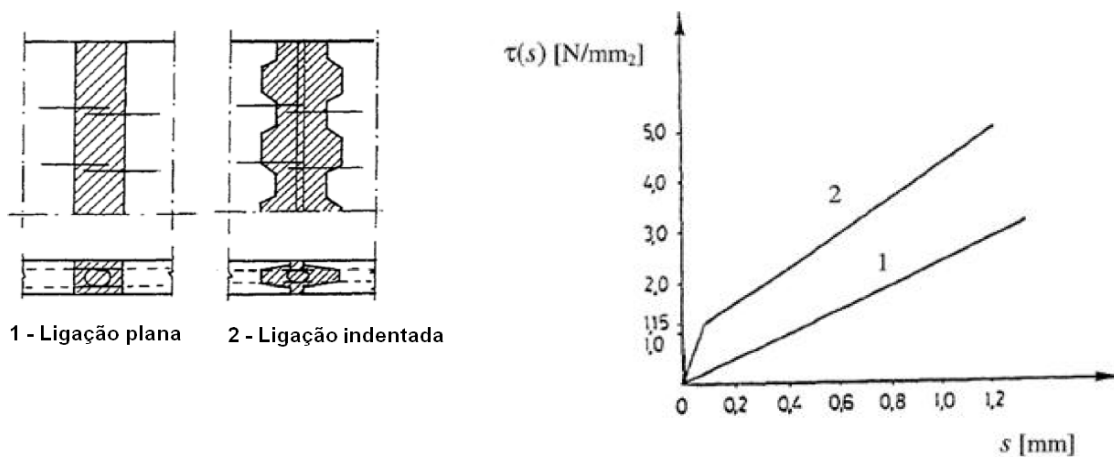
Tensão e escorregamento em junta vertical em painéis de parede (Albarran, 2008)
